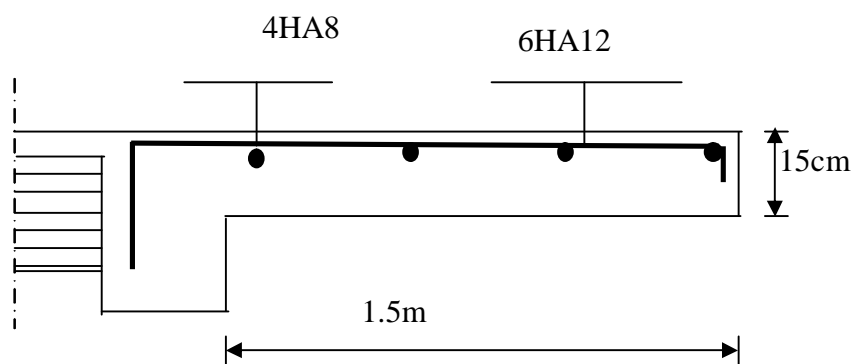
Ferrailage de la dalle pleine de type console.
